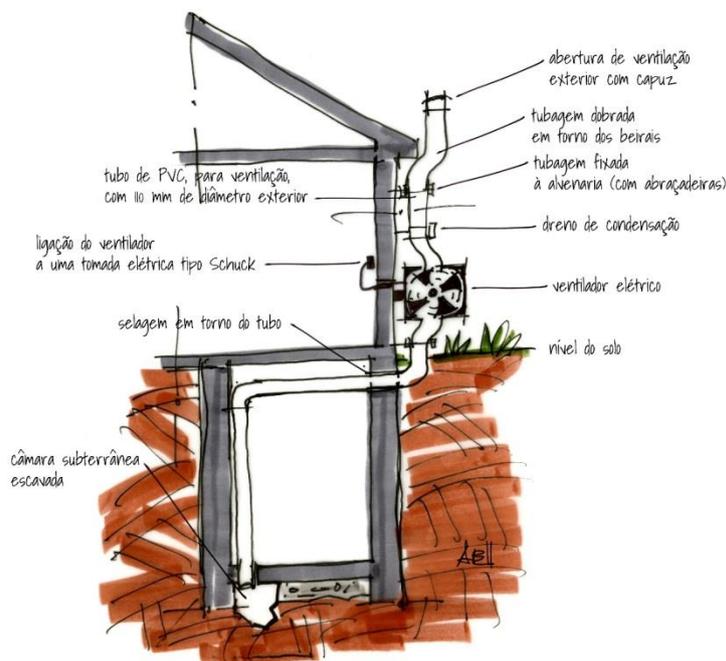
Exemplo de sistema de câmara subterrânea instalada sob o pavimento de uma cave, com condutas e ventilador localizados no exterior
